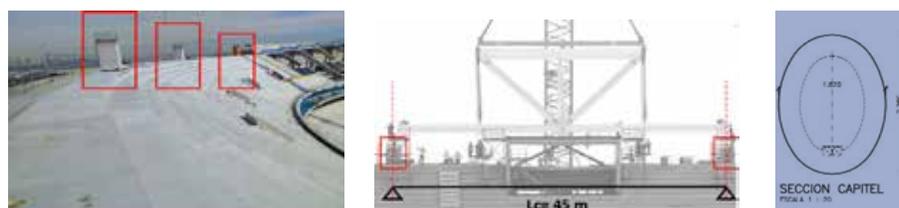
Detalle soportes elevados por sobre el graderío para recibir la cubierta.
